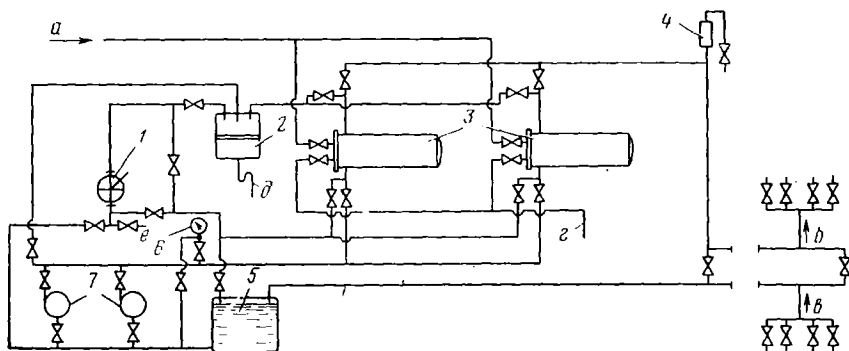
Схема оборудования площадки для подогрева двигателей водой с использованием пароводяных теплообменников:
